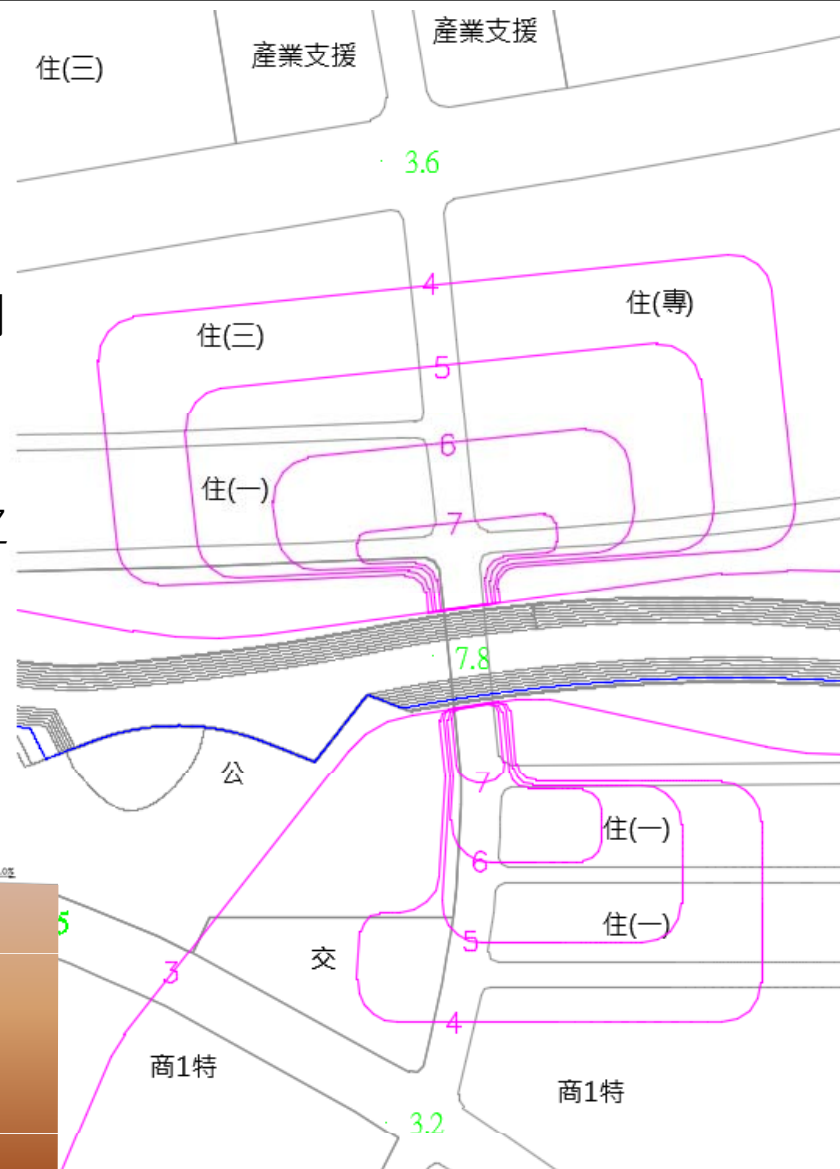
配合船行橋梁整地高程平面示意圖
